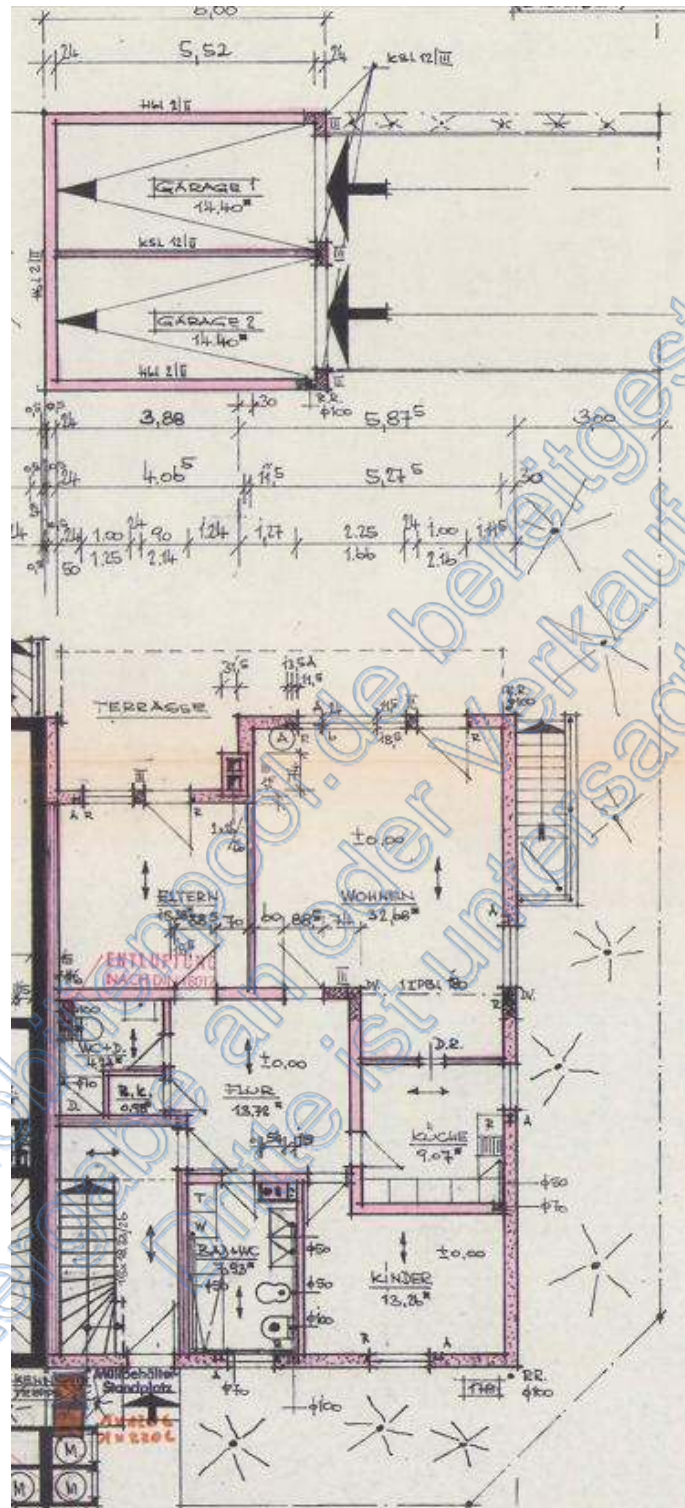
Grundrissplan Erdgeschoss (aus Bauakte)
